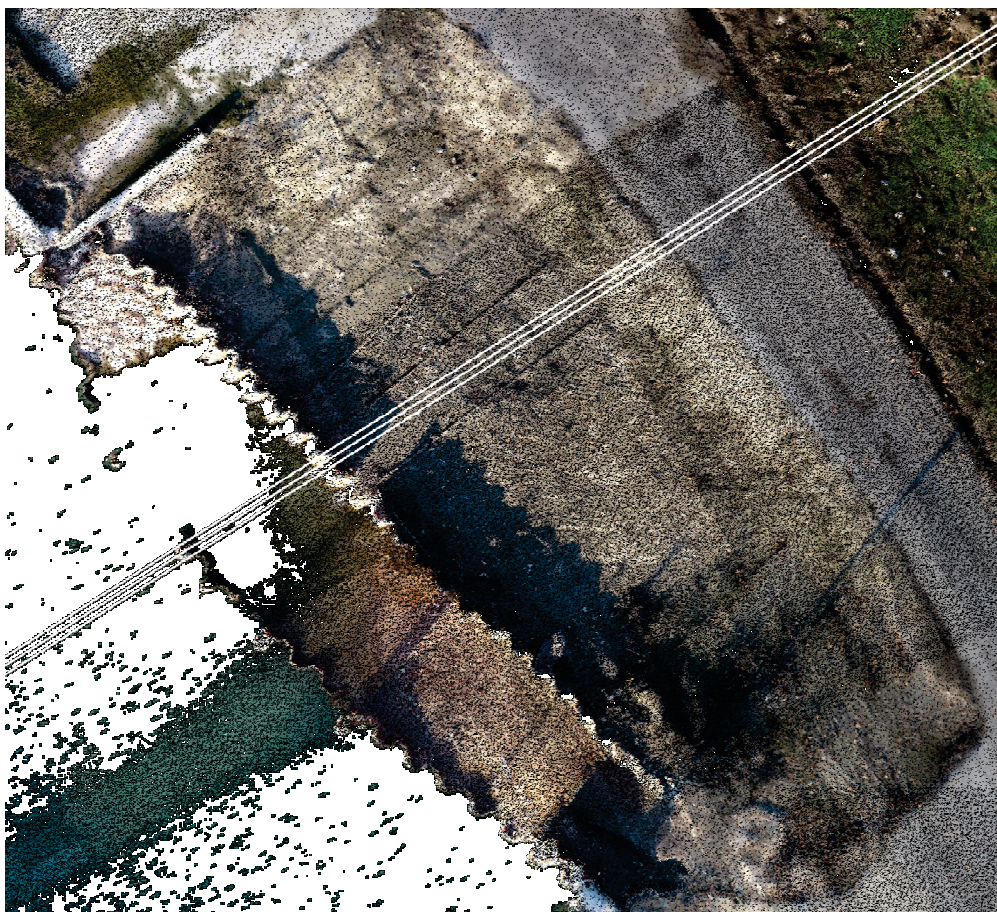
Particolare della nuvola di punti della zona interessata dall'instabilità in vista dall'alto e in sezione da 50cm
